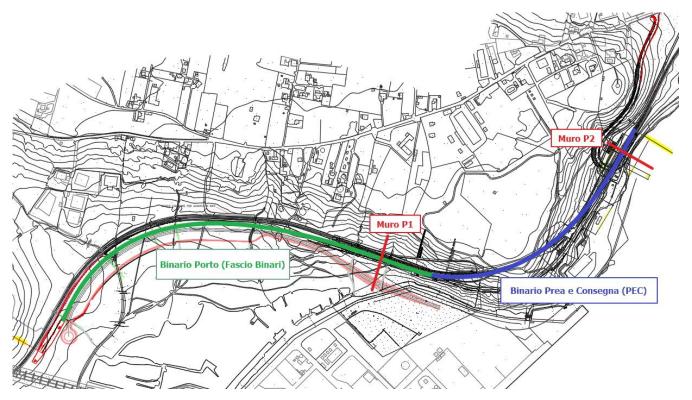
Pianta delle sezioni tipologiche individuate
